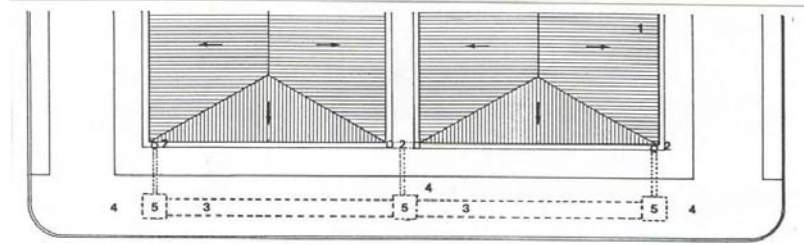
Zanja cubierta. 1.- Techos, 2.- Bajadas de aguas lluvias, 3.- Zanja, 4.- Vereda, 5.- Cámaras.
